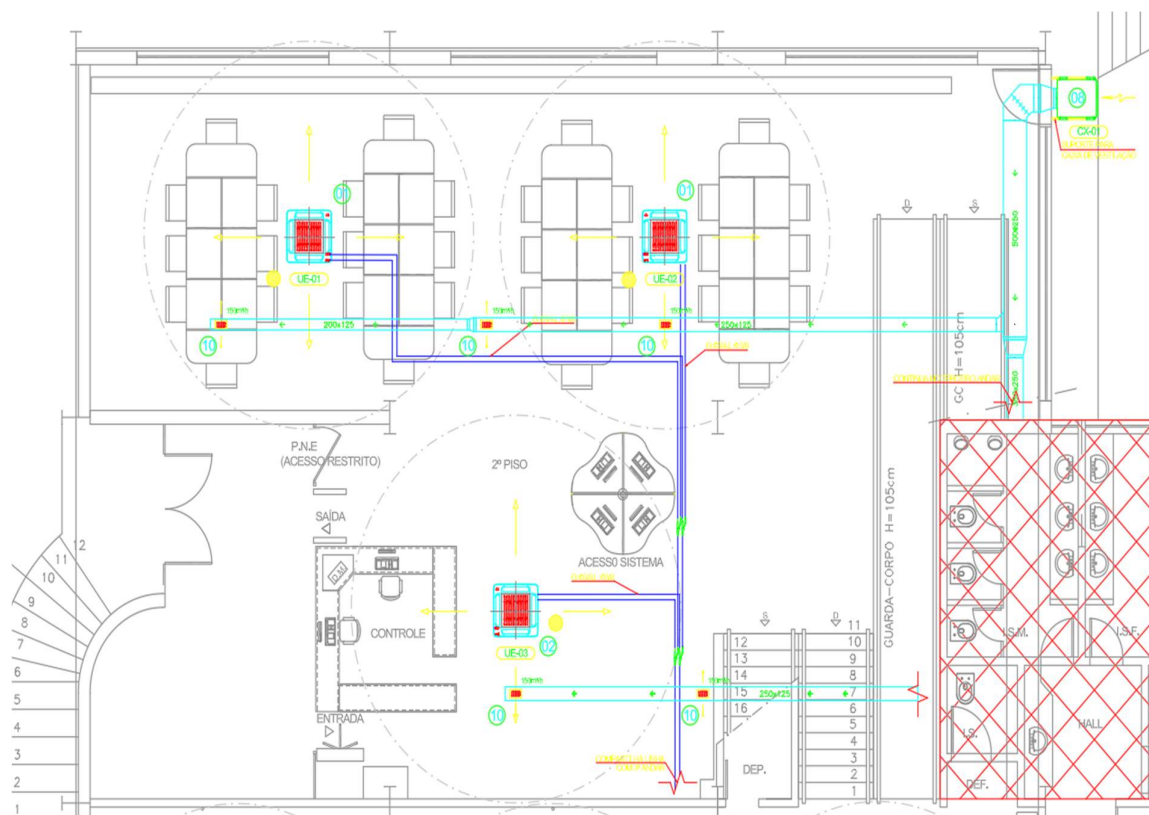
Projeto executivo de climatização, Planta Geral (2º/3º Piso: Hall e Mezanino)
